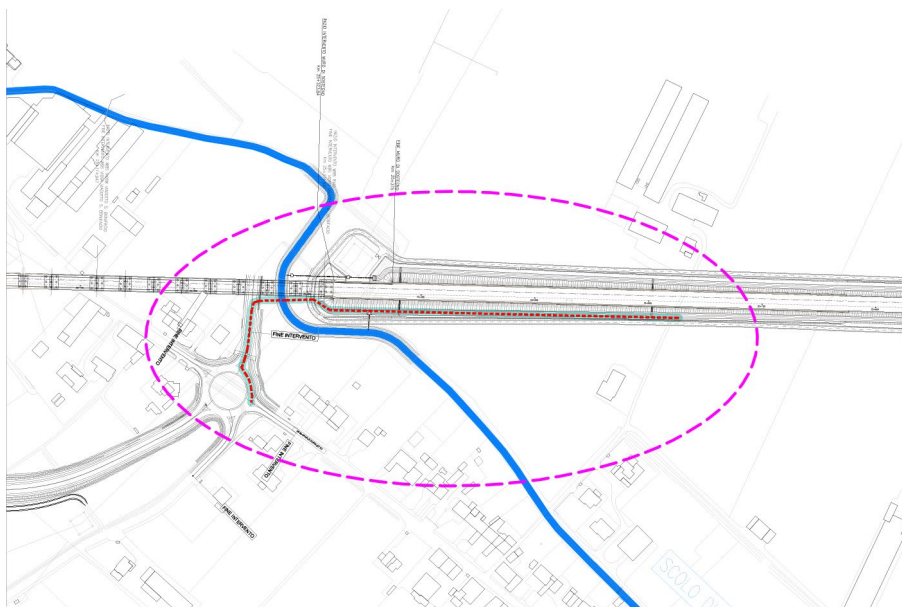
Stralcio Tavola Carta del reticolo idrografico–Tav.1/7, con individuazione delle aree interessate dalle varianti.
